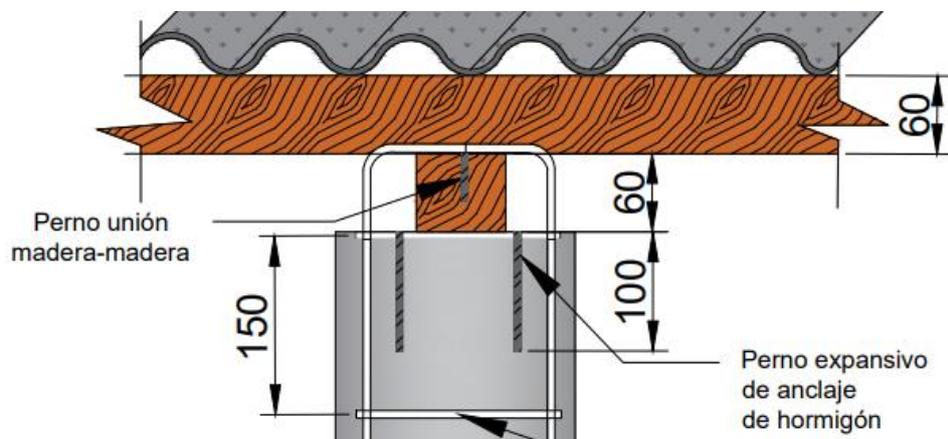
Esquema de conexión restitución de hormigón de la columna [Autores, Unidades: mm]
